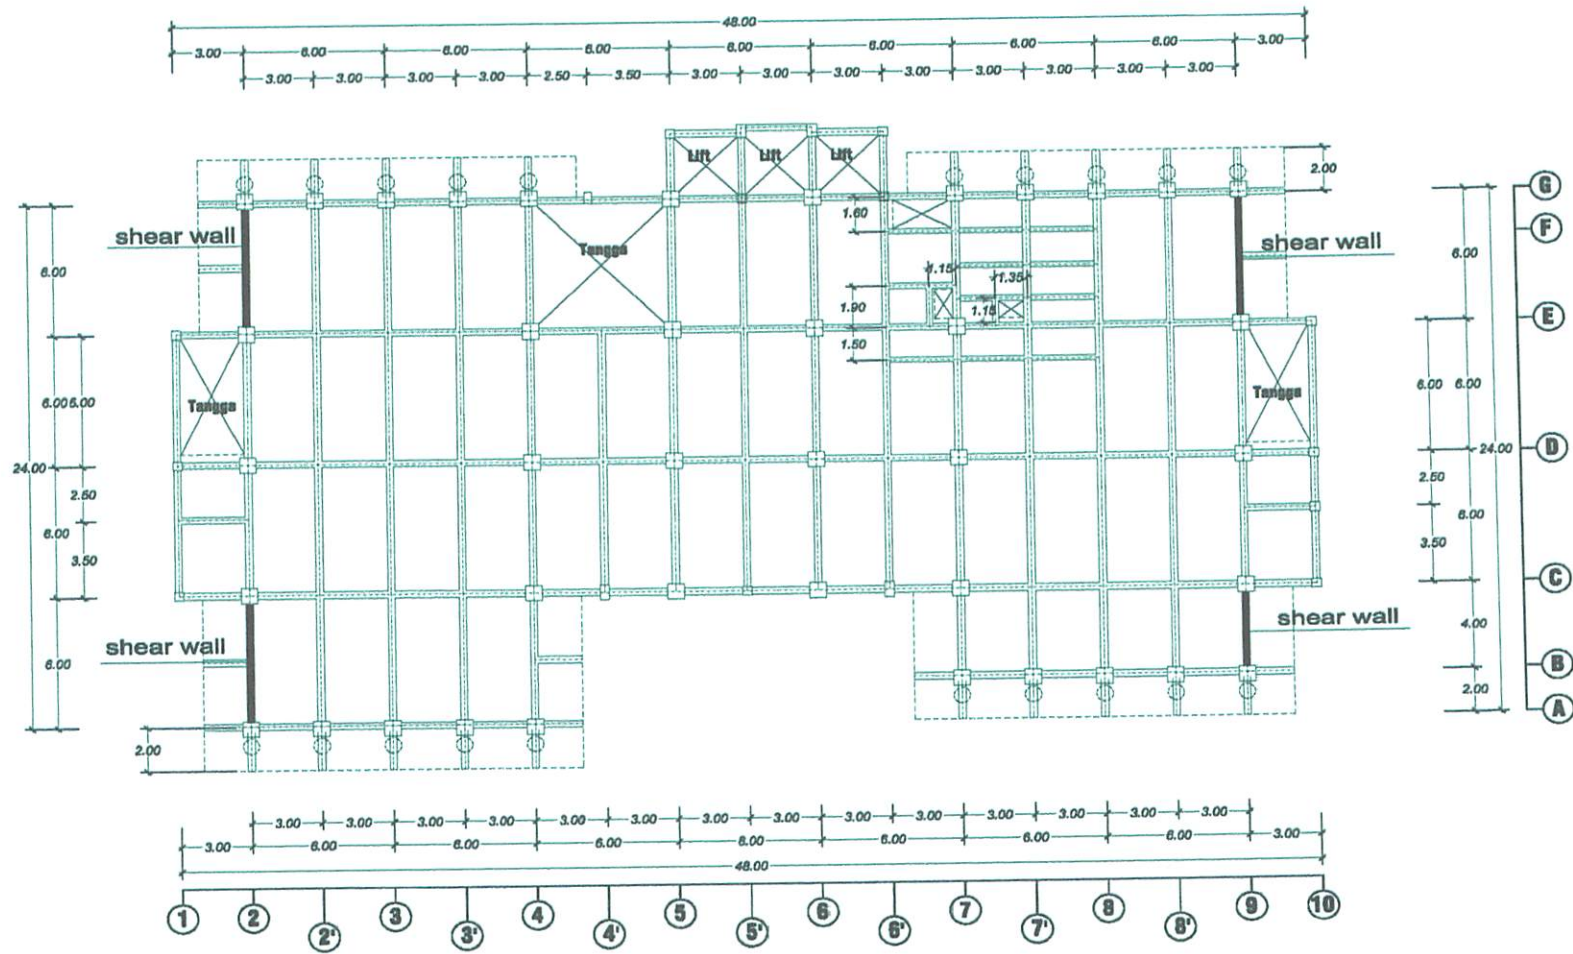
Denah Balok Dan Kolom Lt 7
